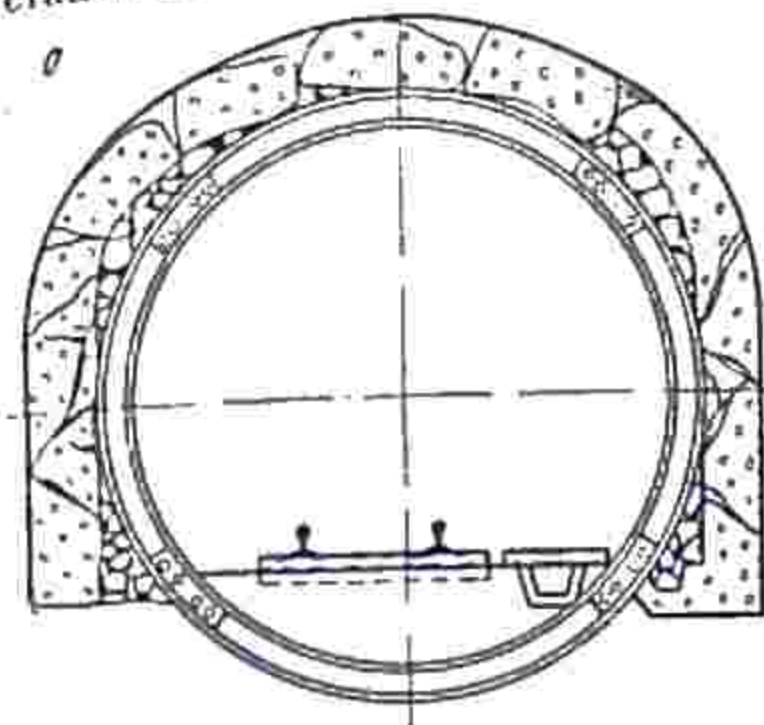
Усиление деформированной бетонной крепи кольцевыми или прямоугольными рамами
